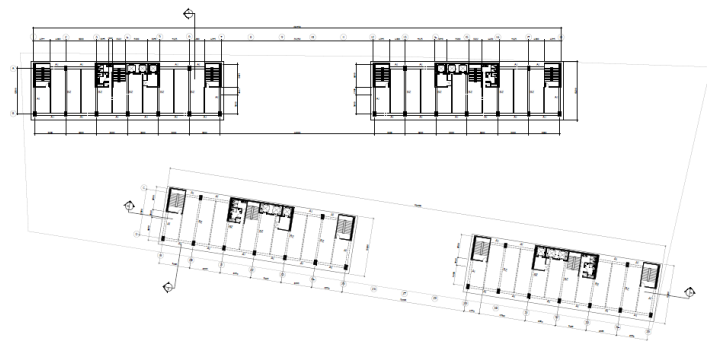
Sistem struktur rangka konstruksi beton.
